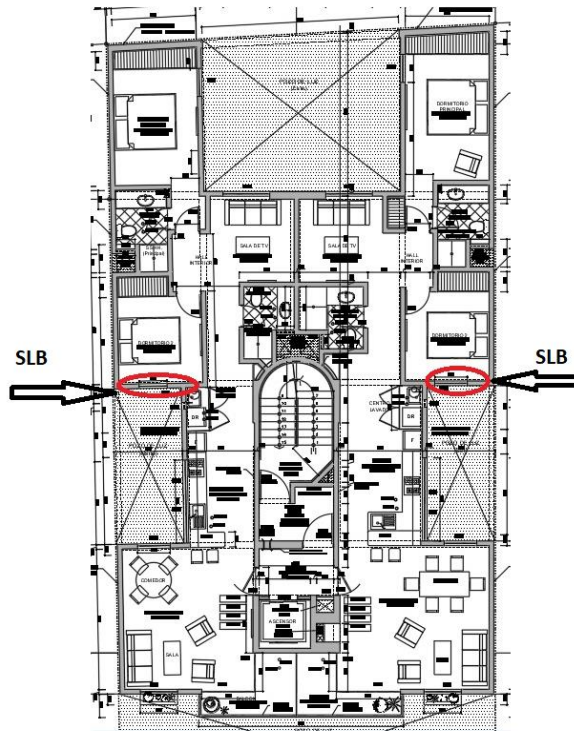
Ubicación pórtico en planta arquitectónica en piso típico
